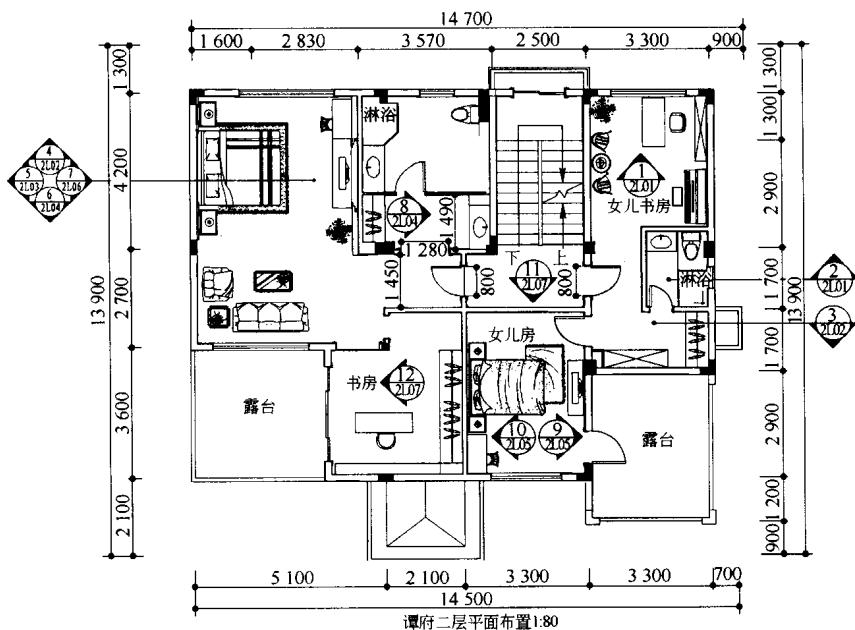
别墅设计二层平面图 (文健、石树勇 设计)
